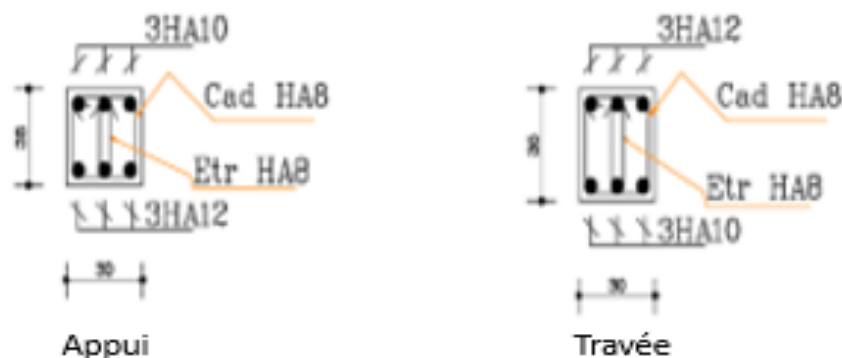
Schéma de ferrailage de la poutre de chinage
